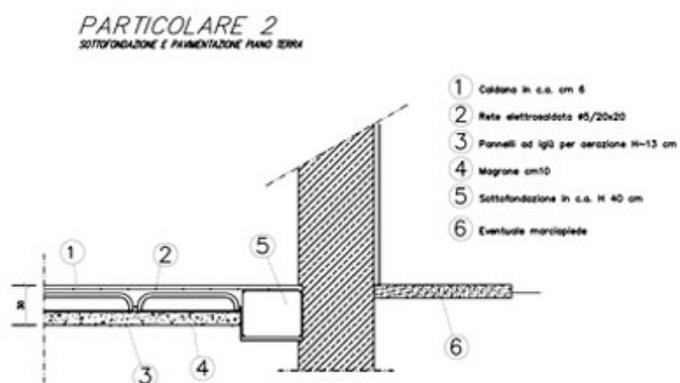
Particolare della sottofondazione e pavimentazione piano terra.
